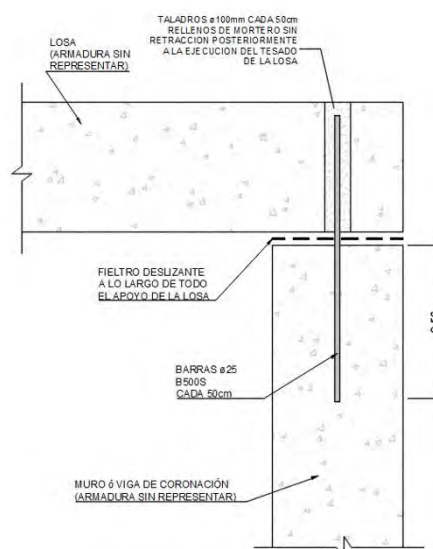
Detalle de conexión de muro perimetral a losa de Planta Primera.
